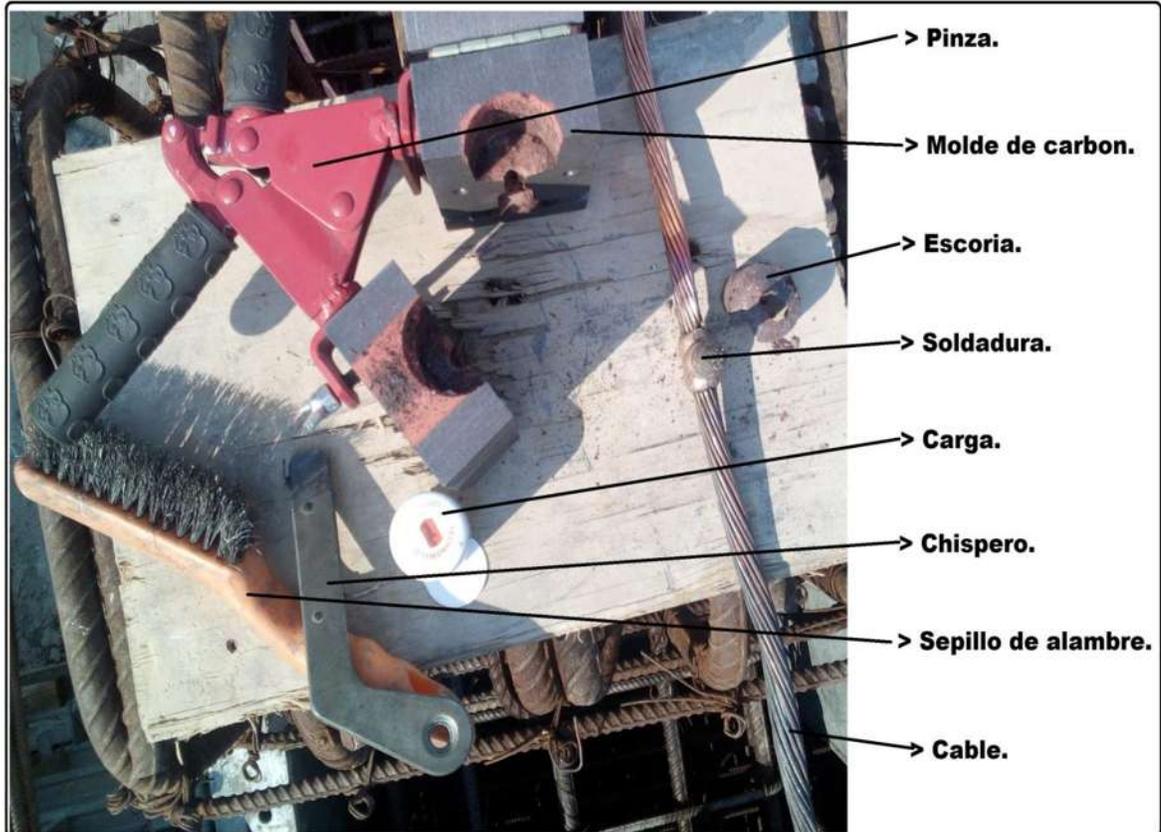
Soldadura Exotérmica trabajo constructivo.
